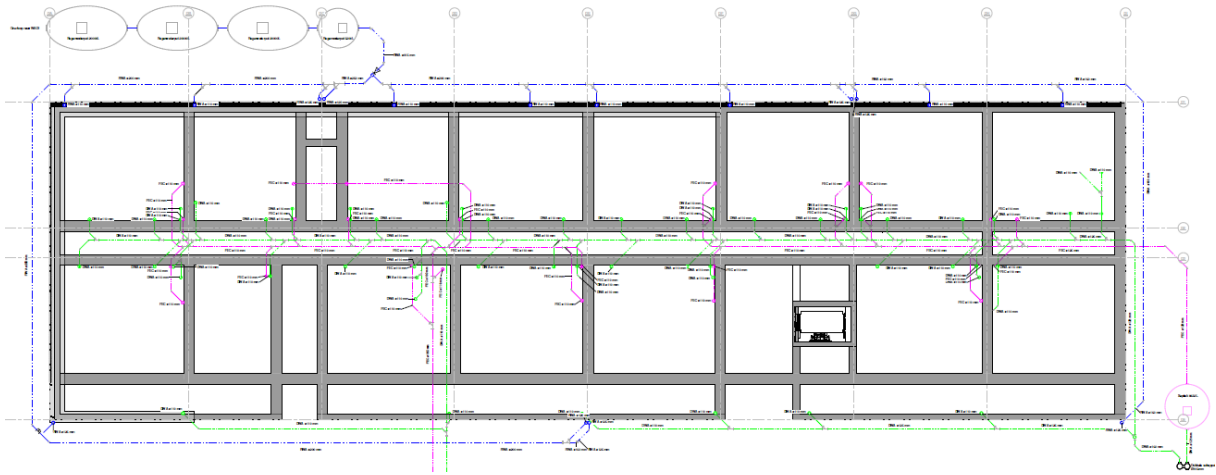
Uitsnede uit snede gebouw B. (Plan aangeleverd door architect B2A1).
